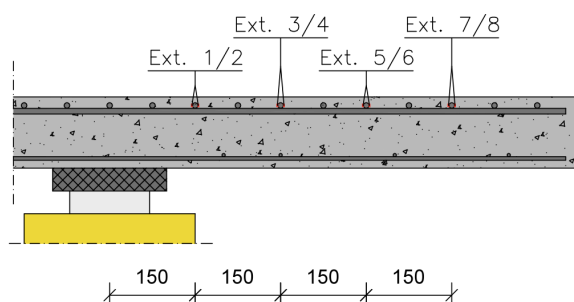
Disposição dos extensómetros na armadura longitudinal superior nos modelos ND1, ND2, ND3, ND4 e ND5 (desenho sem escala e dimensões em mm).
